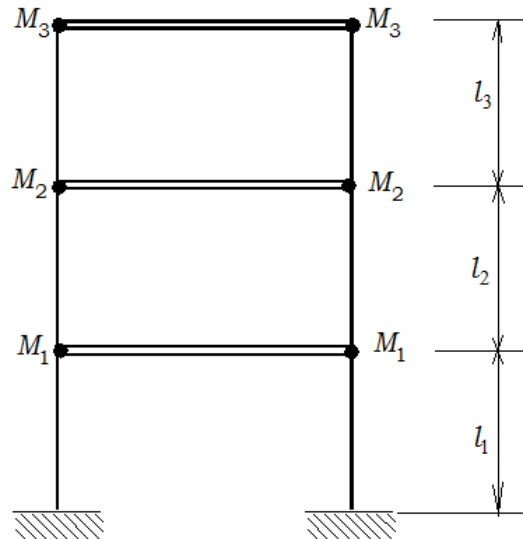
Розрахункова схема рами з абсолютно жорсткими ригелями
